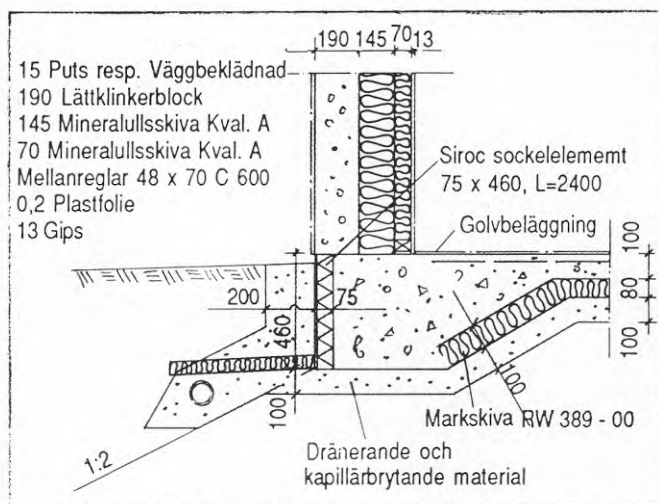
Anslutning mellan grund och lättklinkervägg i Sjuksköterskan. Betongplattan saknar även här isolering under kantbalken.
